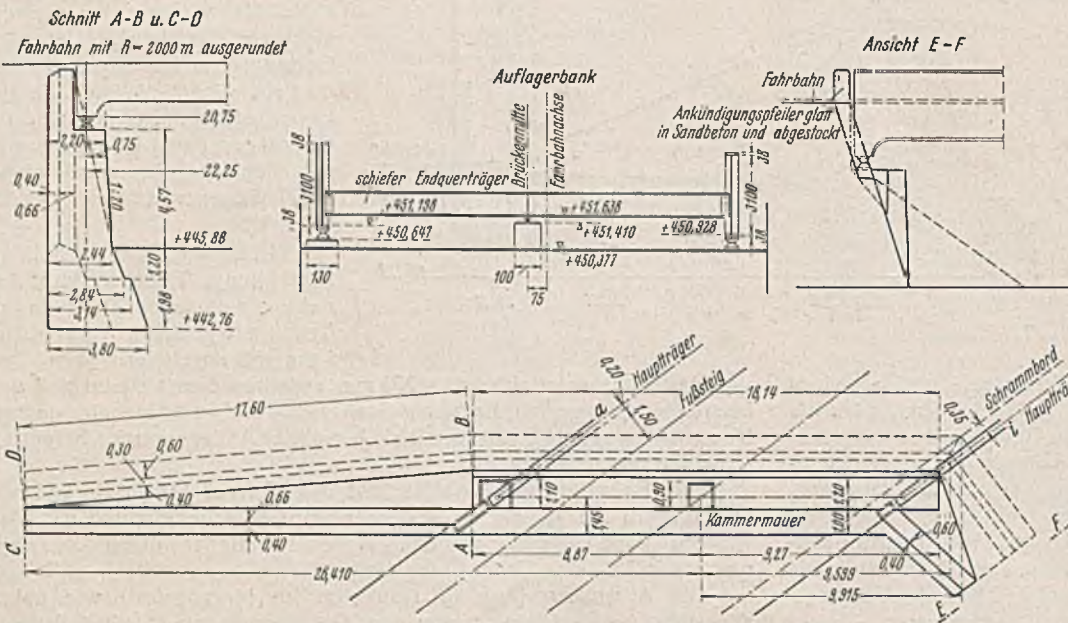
Südöstliches Widerlager mit Auflagerbank.
